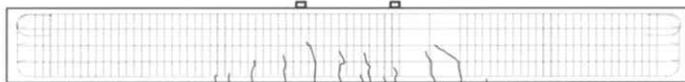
ひび割れ状況図 (斜めひび割れ発生時)
